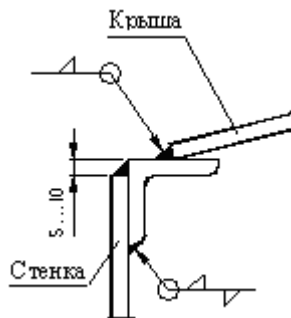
Вузол кріплення даху до верху стінки резервуара
